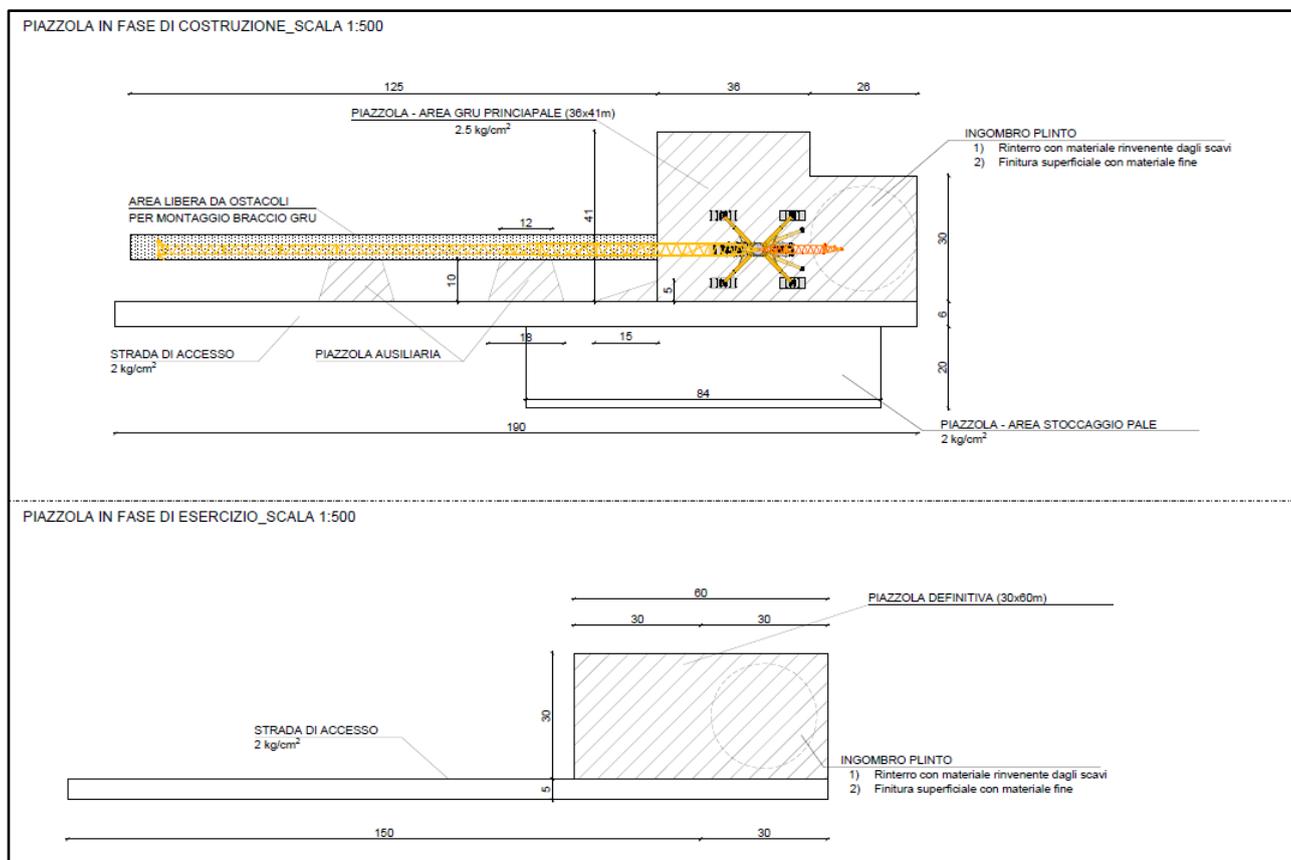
Planimetria piazzola tipo per la fase di installazione e fase di esercizio e manutenzione
